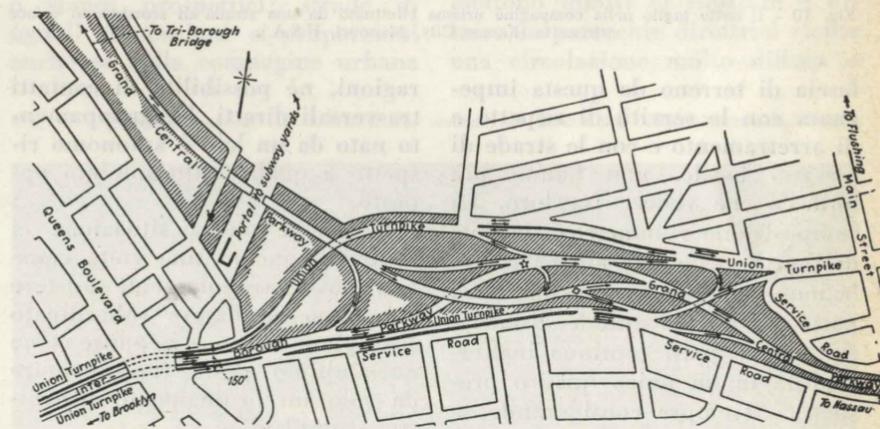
Planimetria di strada di scorrimento veloce e nodo di smistamento (Long Island, presso Kew Garden, U.S.A.).
